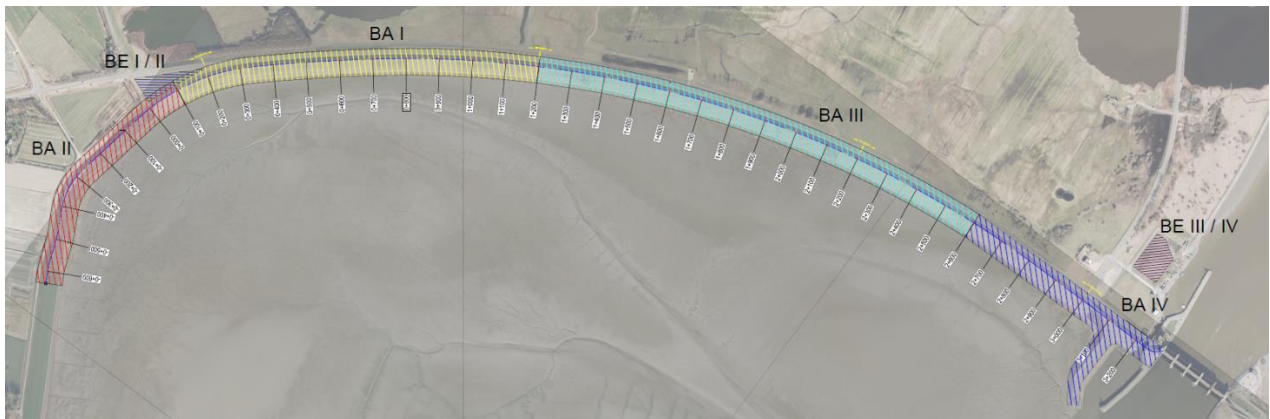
Lageplan Baustelleneinrichtung sowie zugehörige Bauabschnitte
